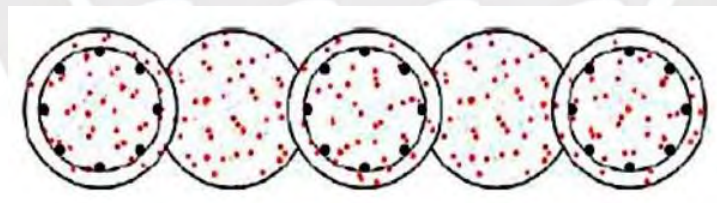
Armado de pilote primarios en pantalla de pilotes secantes duro/blando y duro/firme. (Fuente: Cementation Skanska, 2009)
